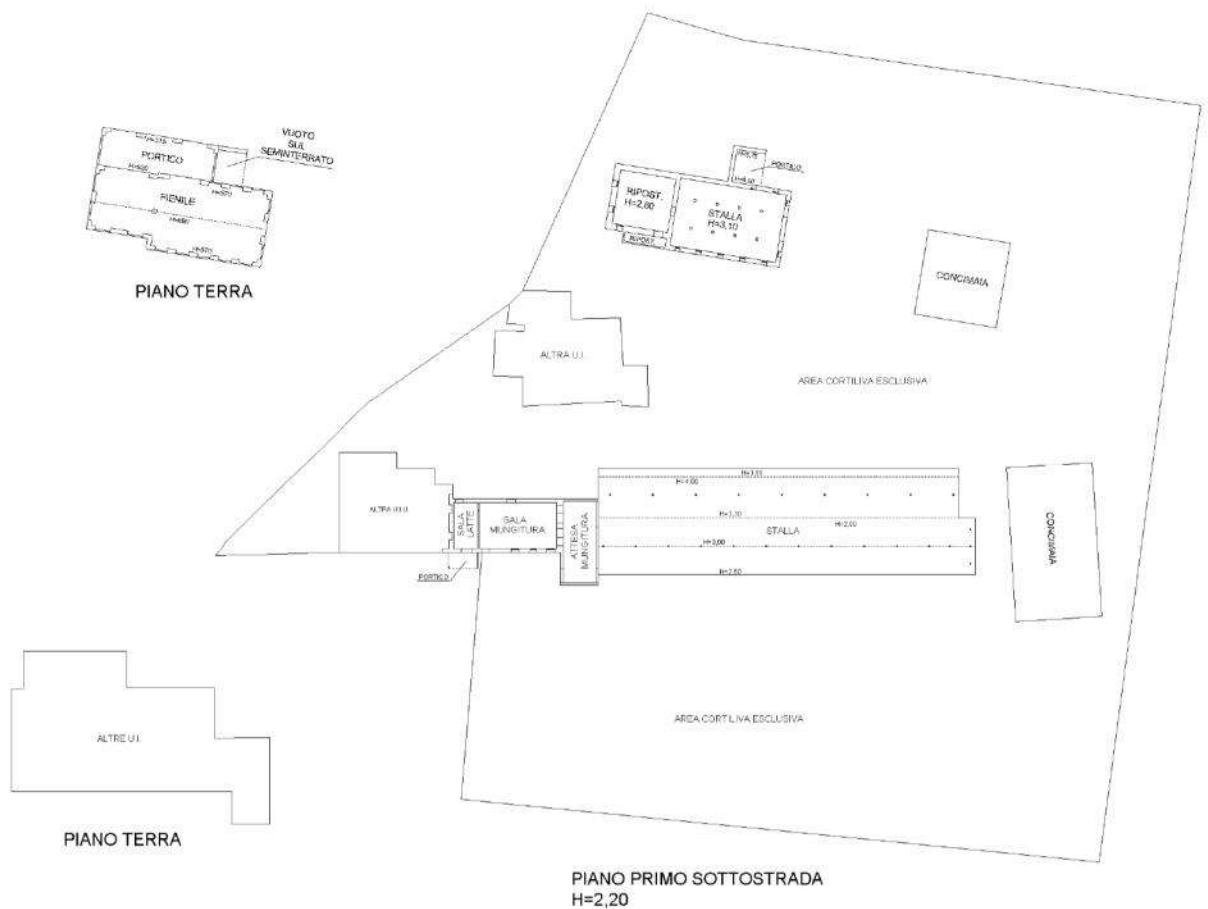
planimetrie catastali complesso zootecnico sub. 5.
